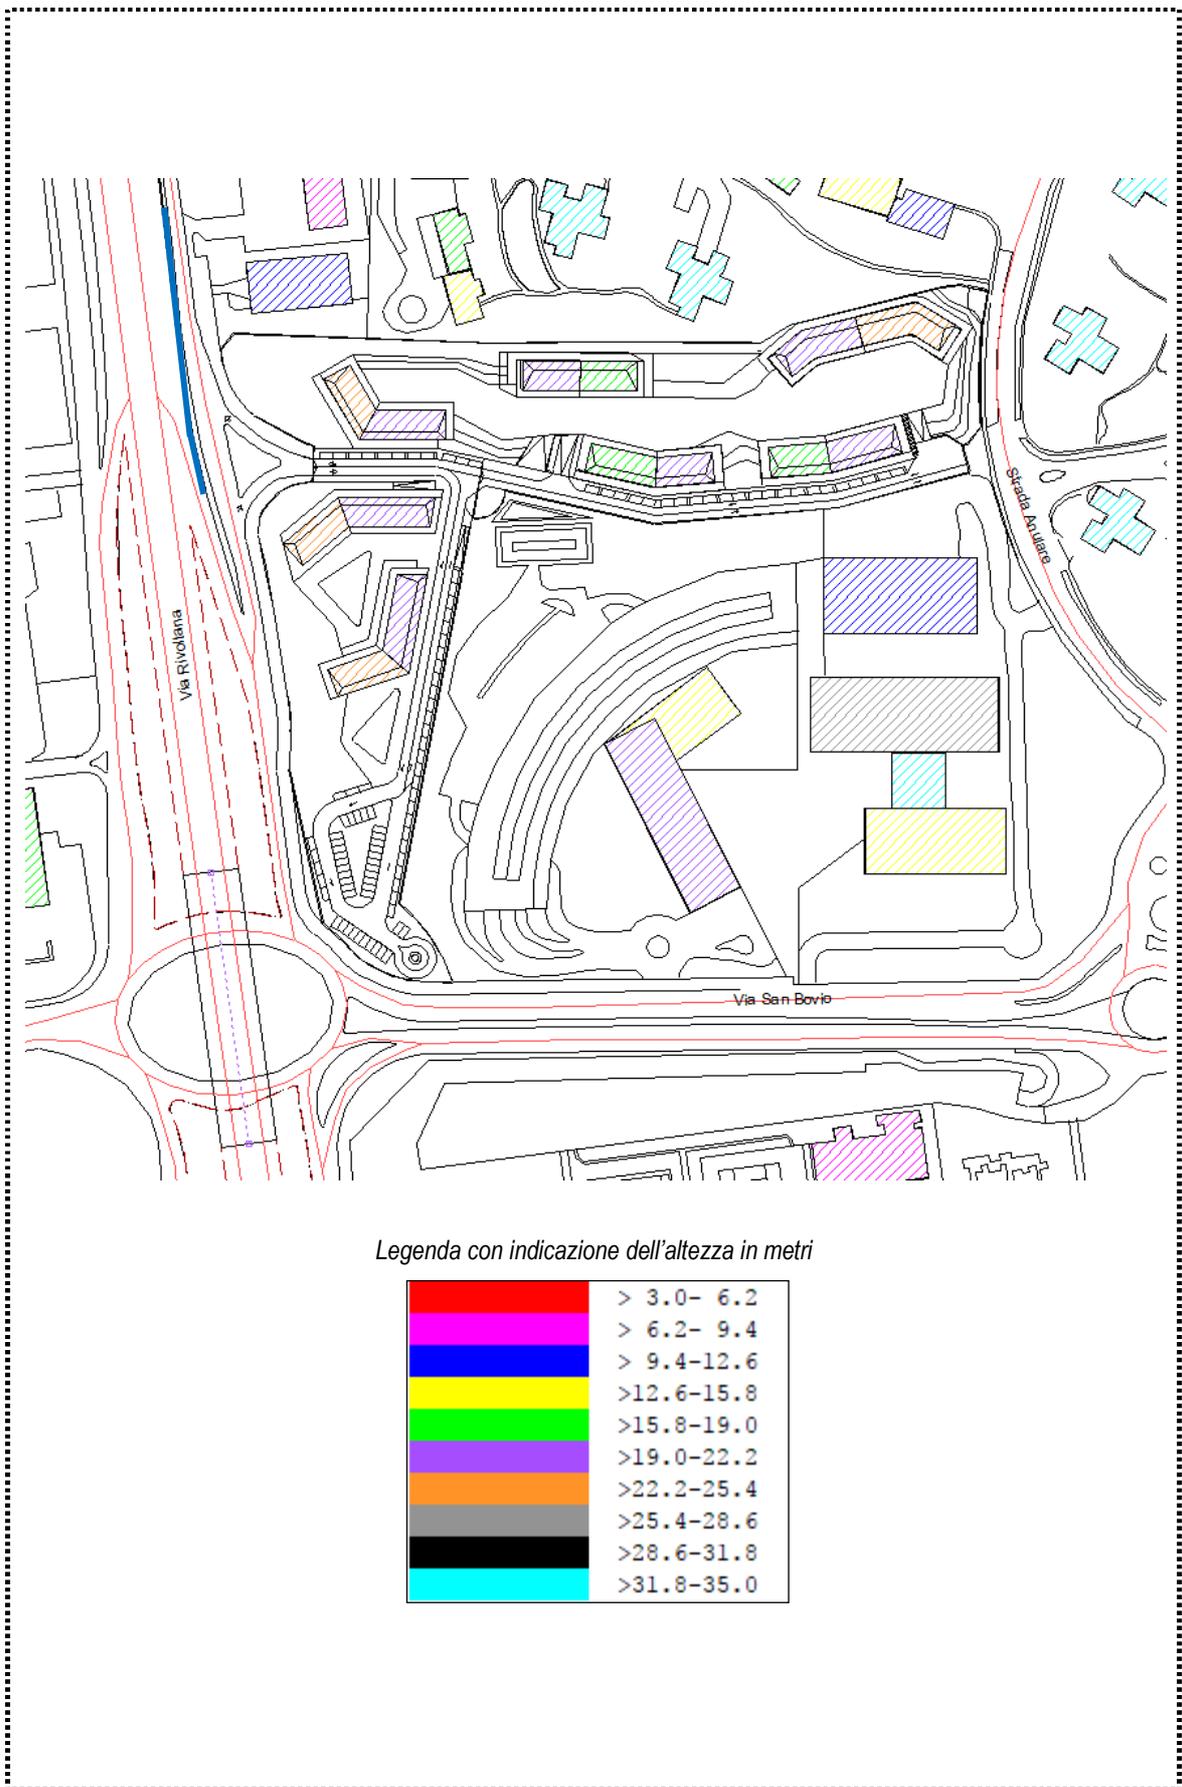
Planimetria con indicazione dell'altezza degli edifici allo stato di progetto
